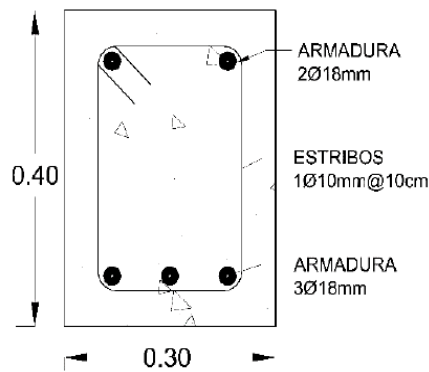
Sección transversal de la viga (Tomado de Cabrera & Sánchez, 2016)
